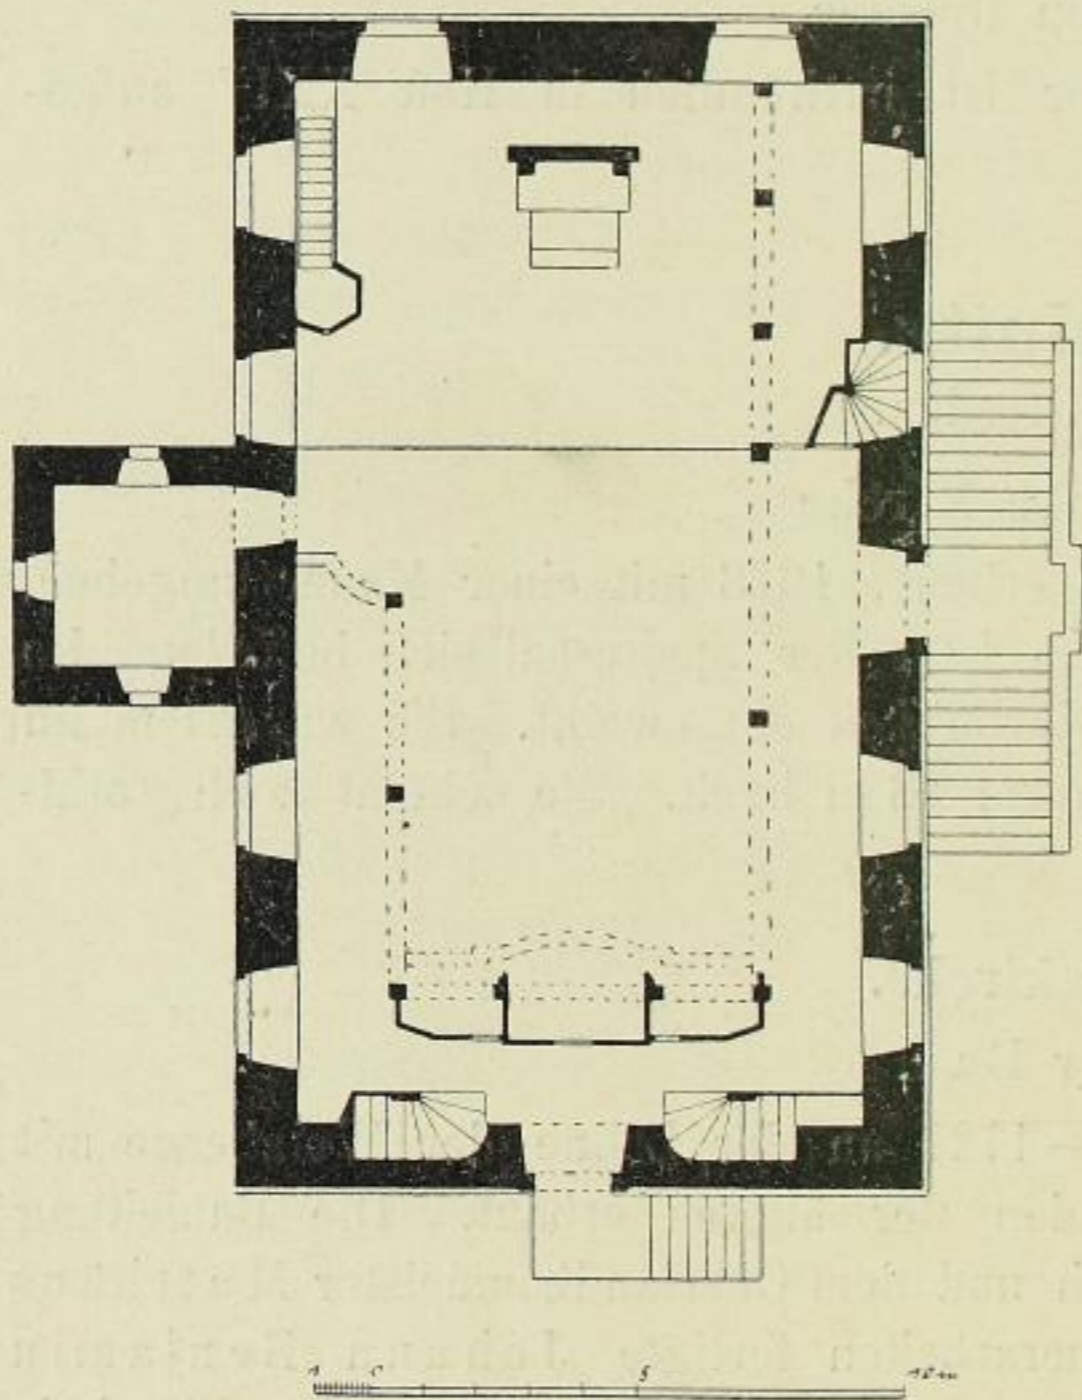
Pillnitz, Bergkirche, Grundriss.
